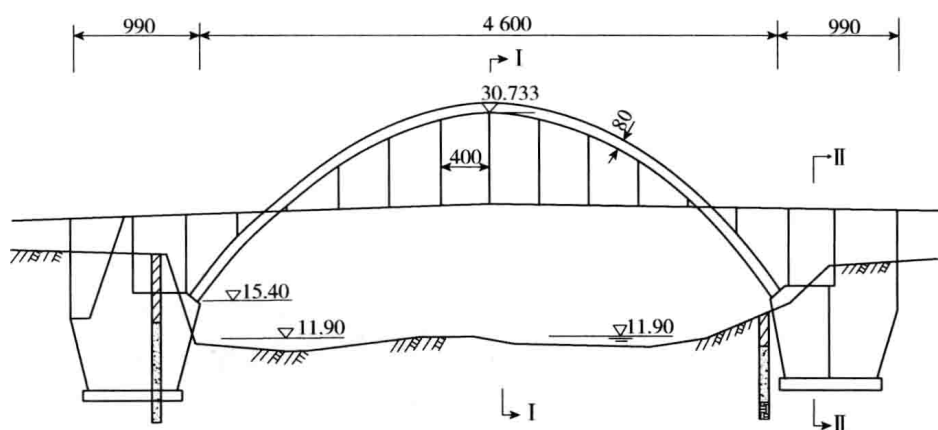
立面图(尺寸单位:cm;高程单位:m)
